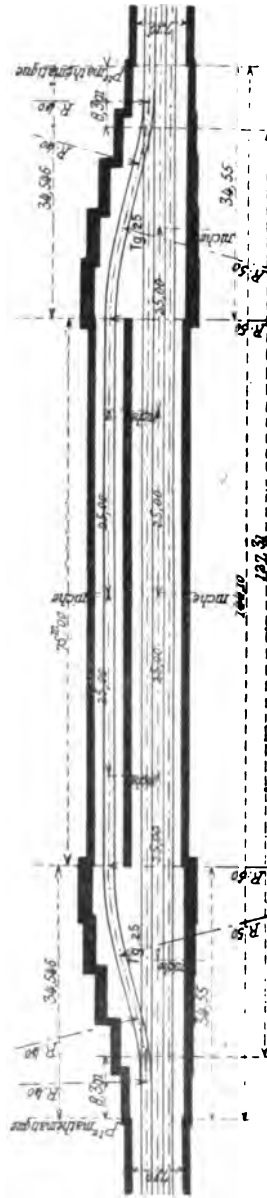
(Éch. 1/1000). — Garage des Arts-et-Métiers. Plan général.
